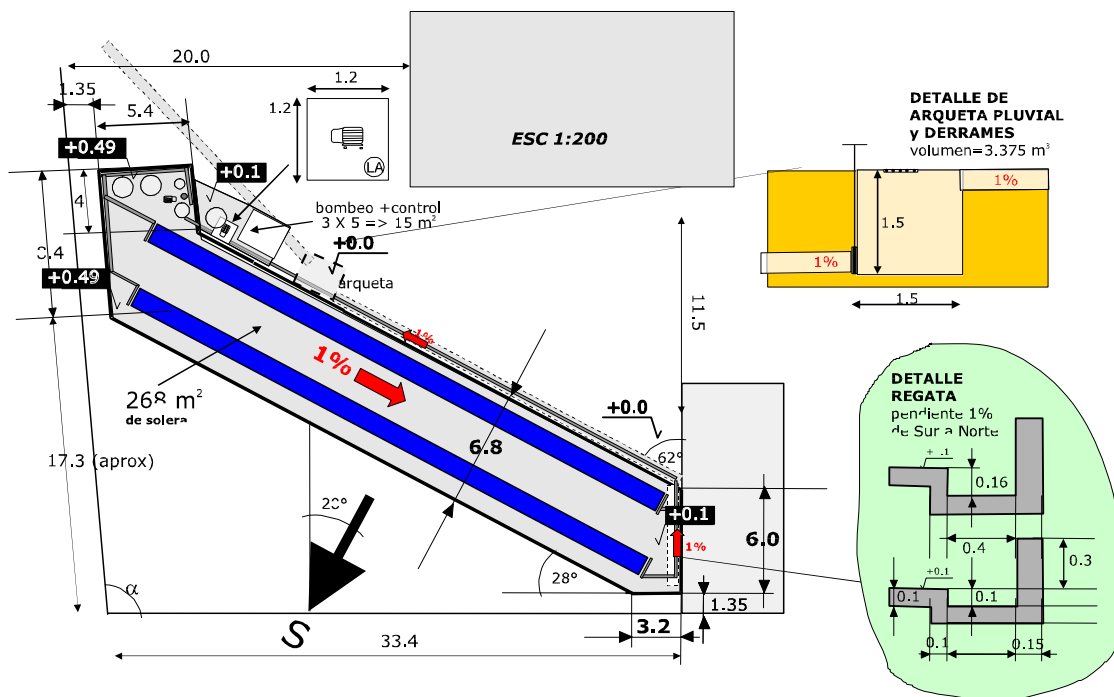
Plano acotado de planteamiento y distribución de la planta de fotocátalisis solar
